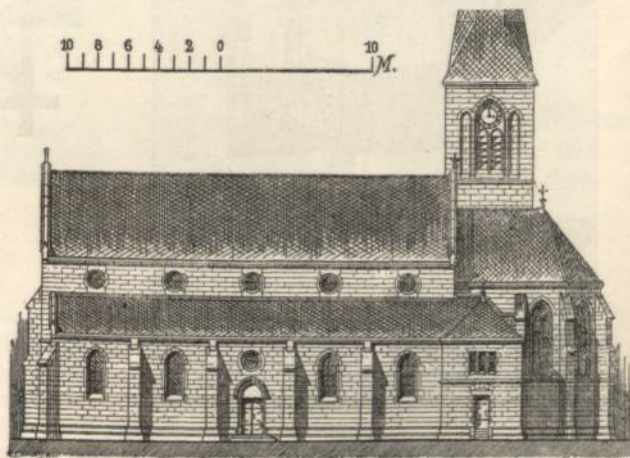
Südfaçade. Kirche in Dotternhausen (Architekt Cades).
